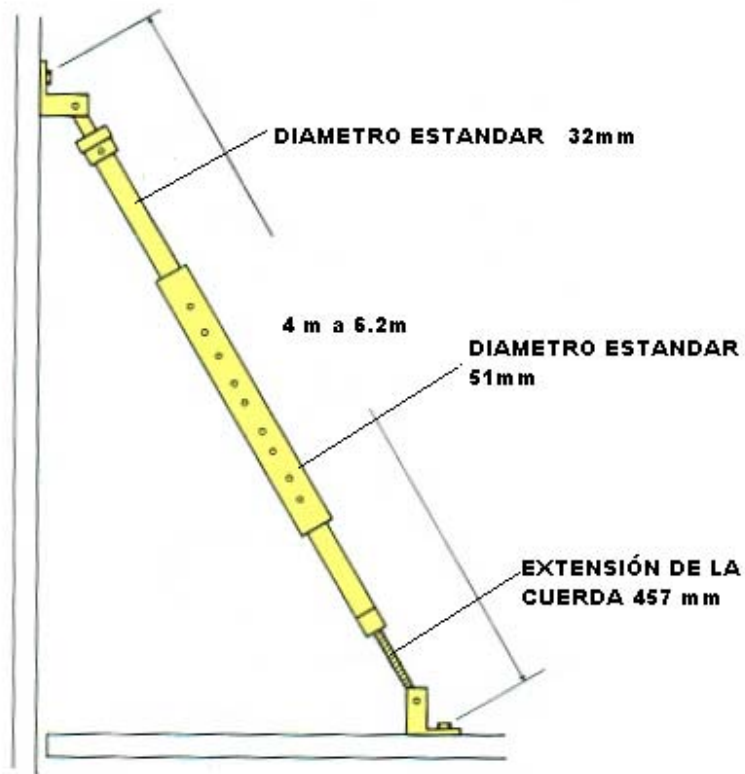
b Tubo telescópico con alcancé de 4 a 6 m.
